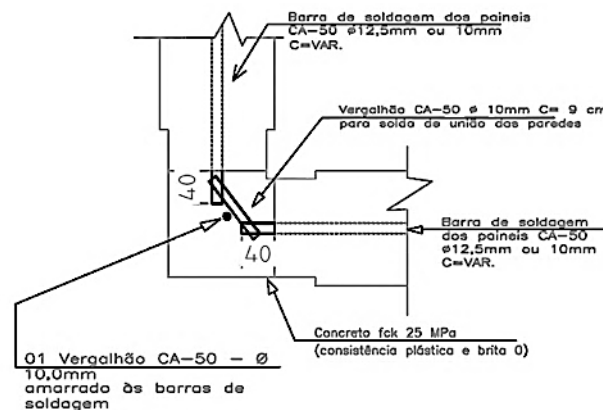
Detalhe esquemático da ligação entre dois painéis.
